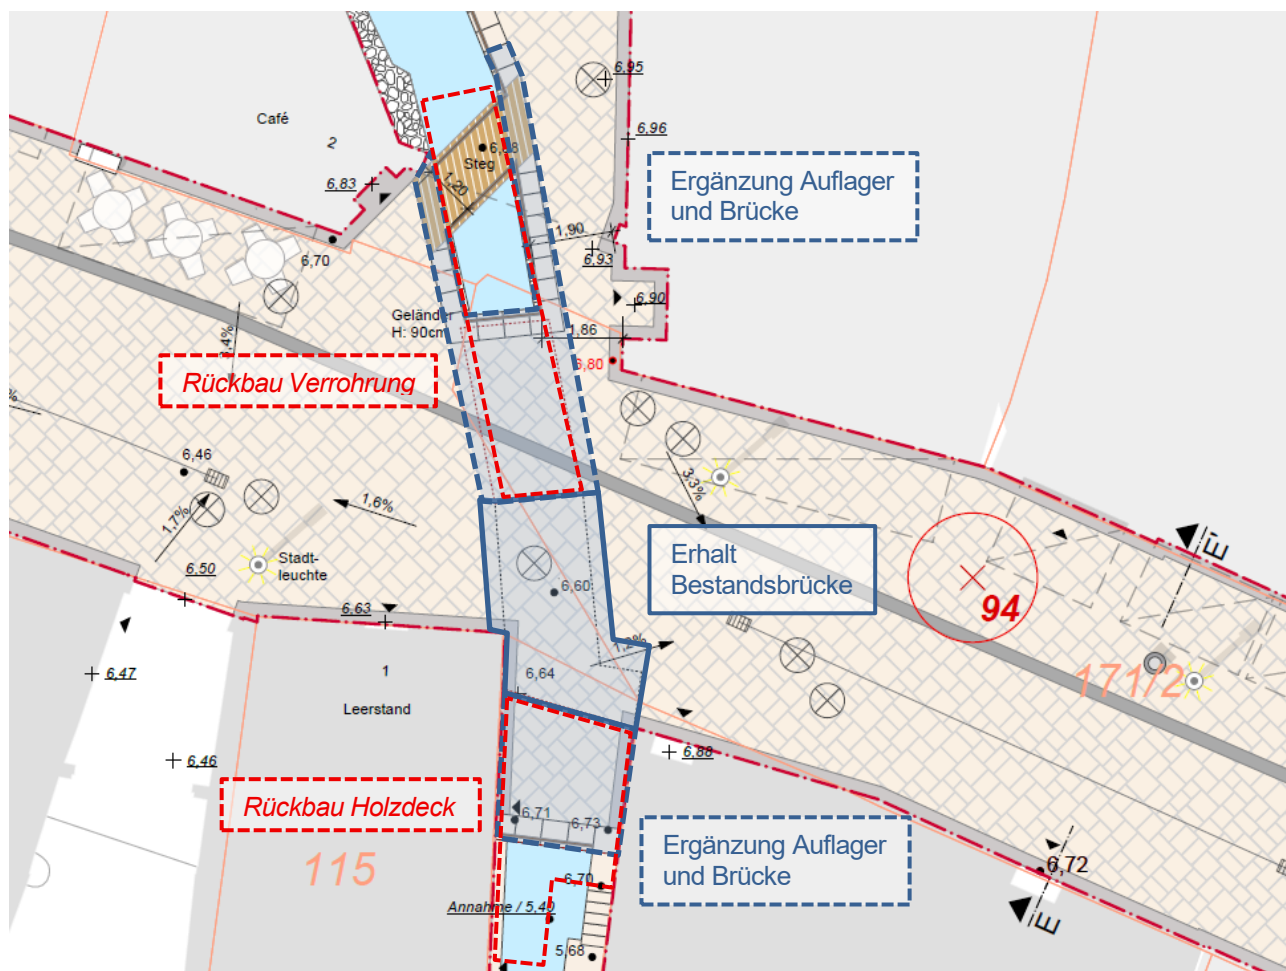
Gliederung Umbaumaßnahmen Brücke Mönchenbrückstraße, aktueller Stand, capattistaubach | urbane landschaften & iplan nord gmbh (ARGE Erschließungsanlagen Schleswig)
